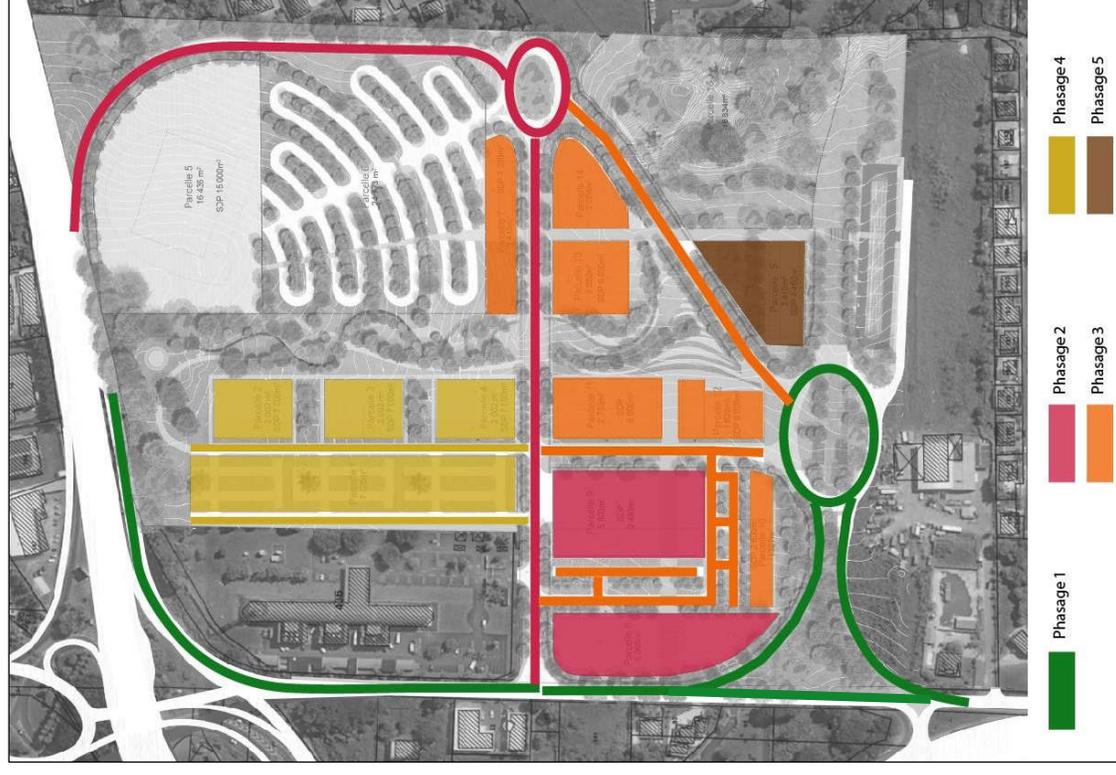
Plan de phasage des travaux. (Source : Adoho)
